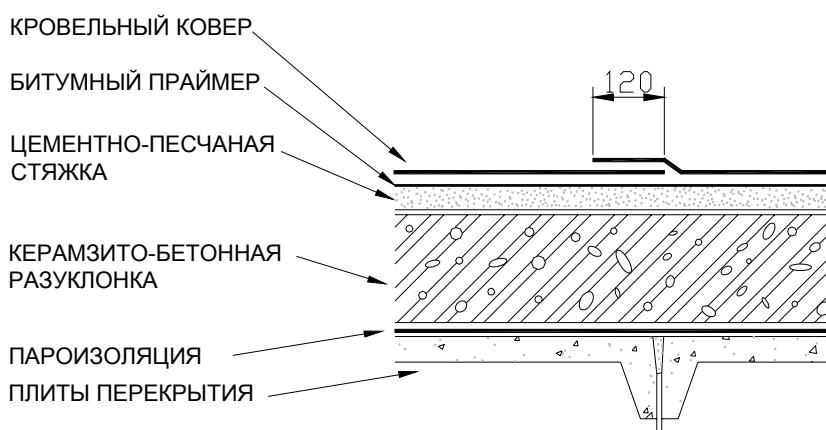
Кровельный ковер по керамзито-бетонной разуклонке с армированной цементно-песчаной стяжкой.
